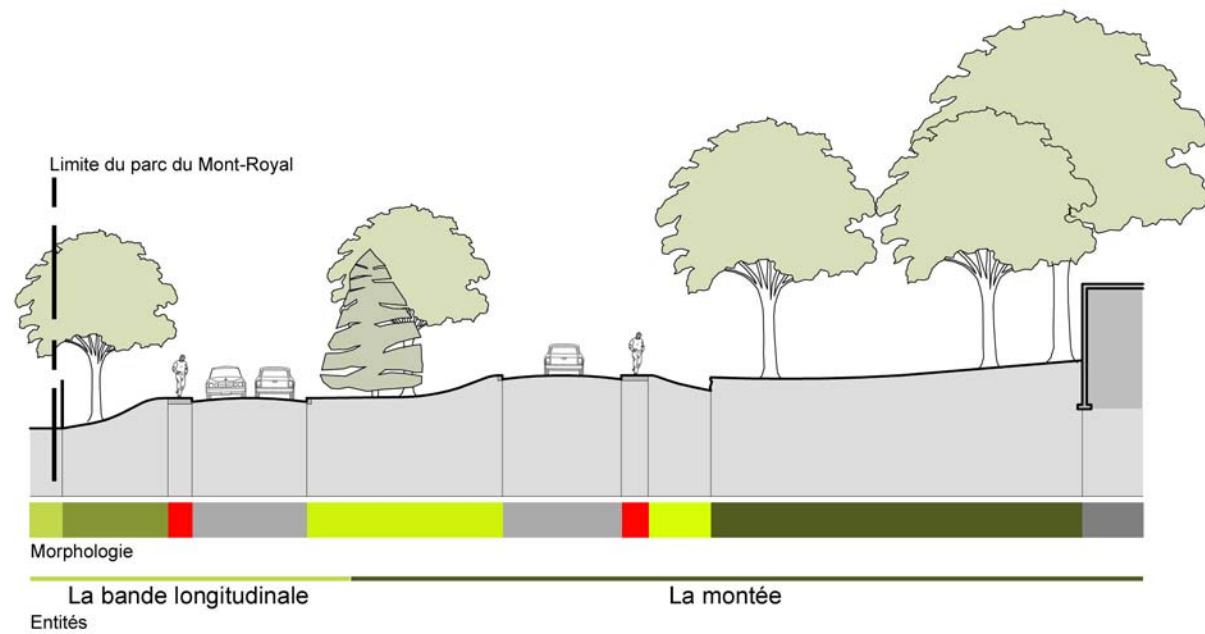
Coupe transversale 02, échelle 1:500, la bande longitudinale et la montée
